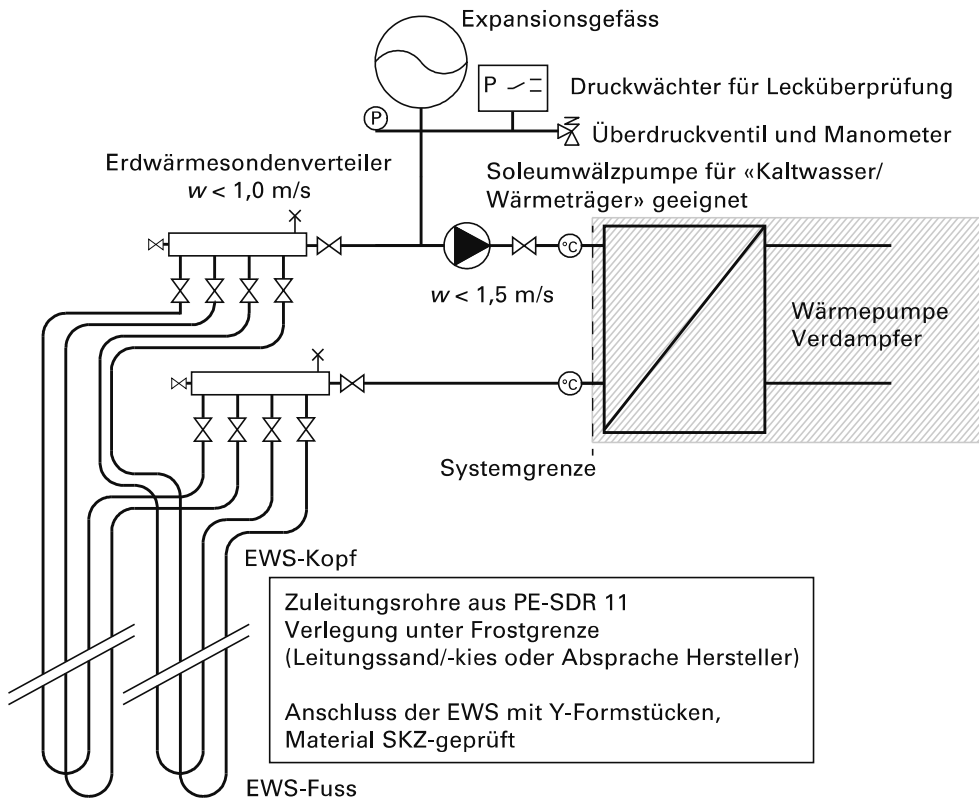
Prinzipschema für eine Erdwärmesonde, angeschlossen mit Y-Formstück
